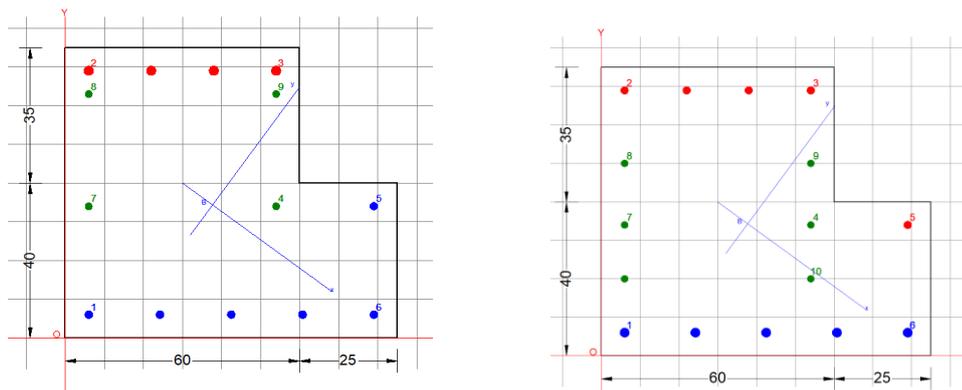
Sezione all'appoggio a SX e Sezione in campata a DX.
